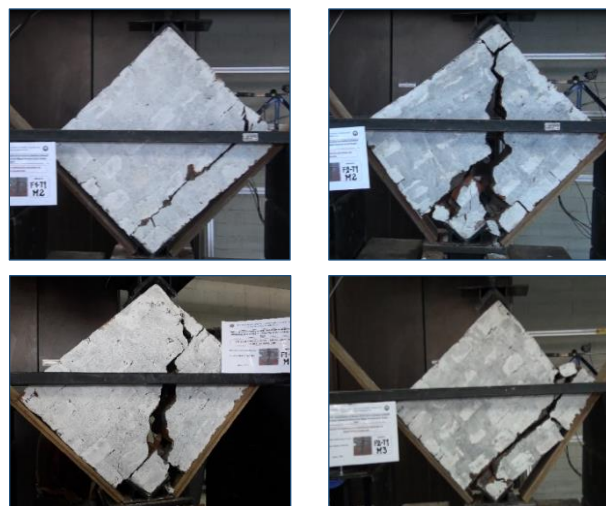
Fallas mixtas y por cizalle en muretes - T1.
